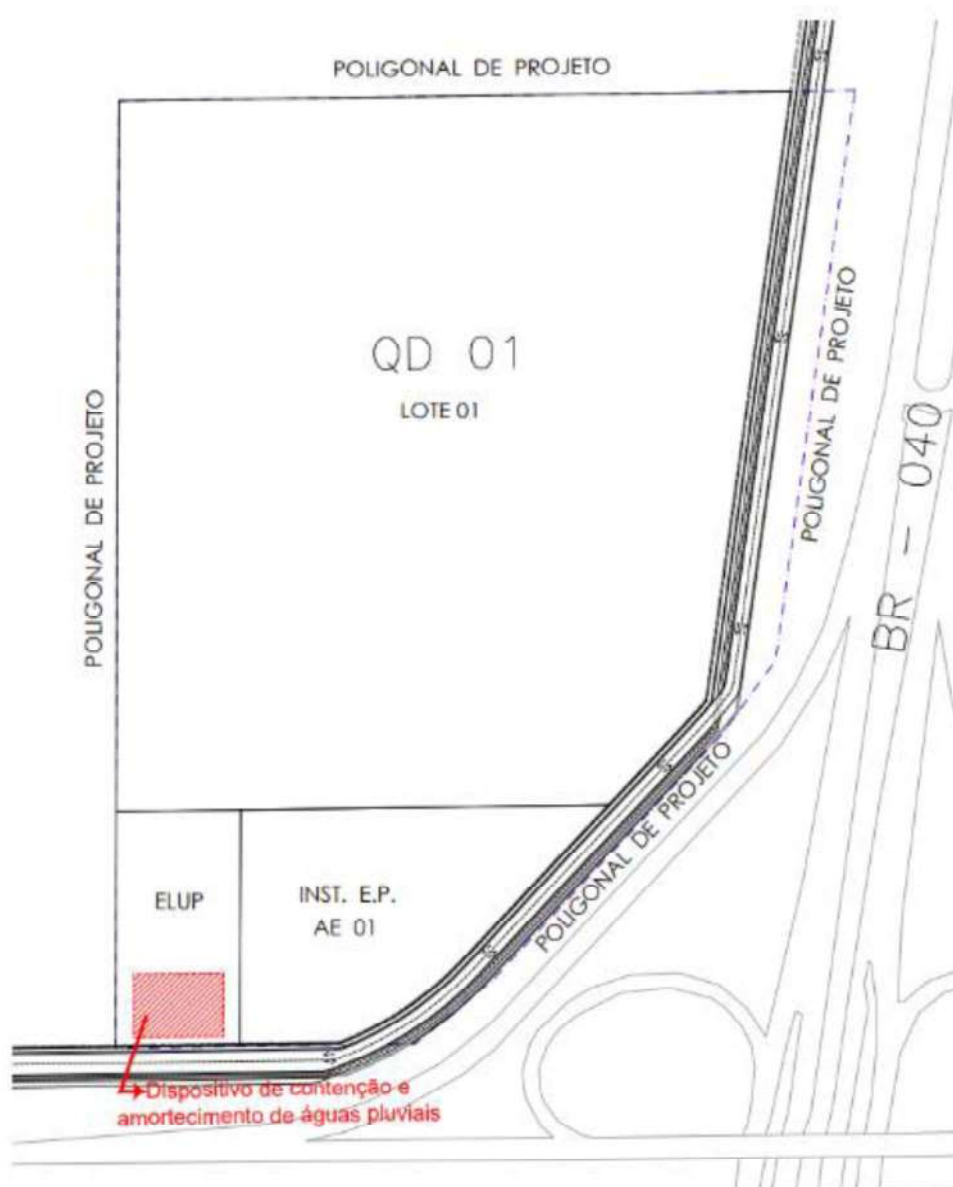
Localização do dispositivo de contenção e amortecimento de águas pluviais dentro da ELUP. Fonte: MDE 283/2022.
